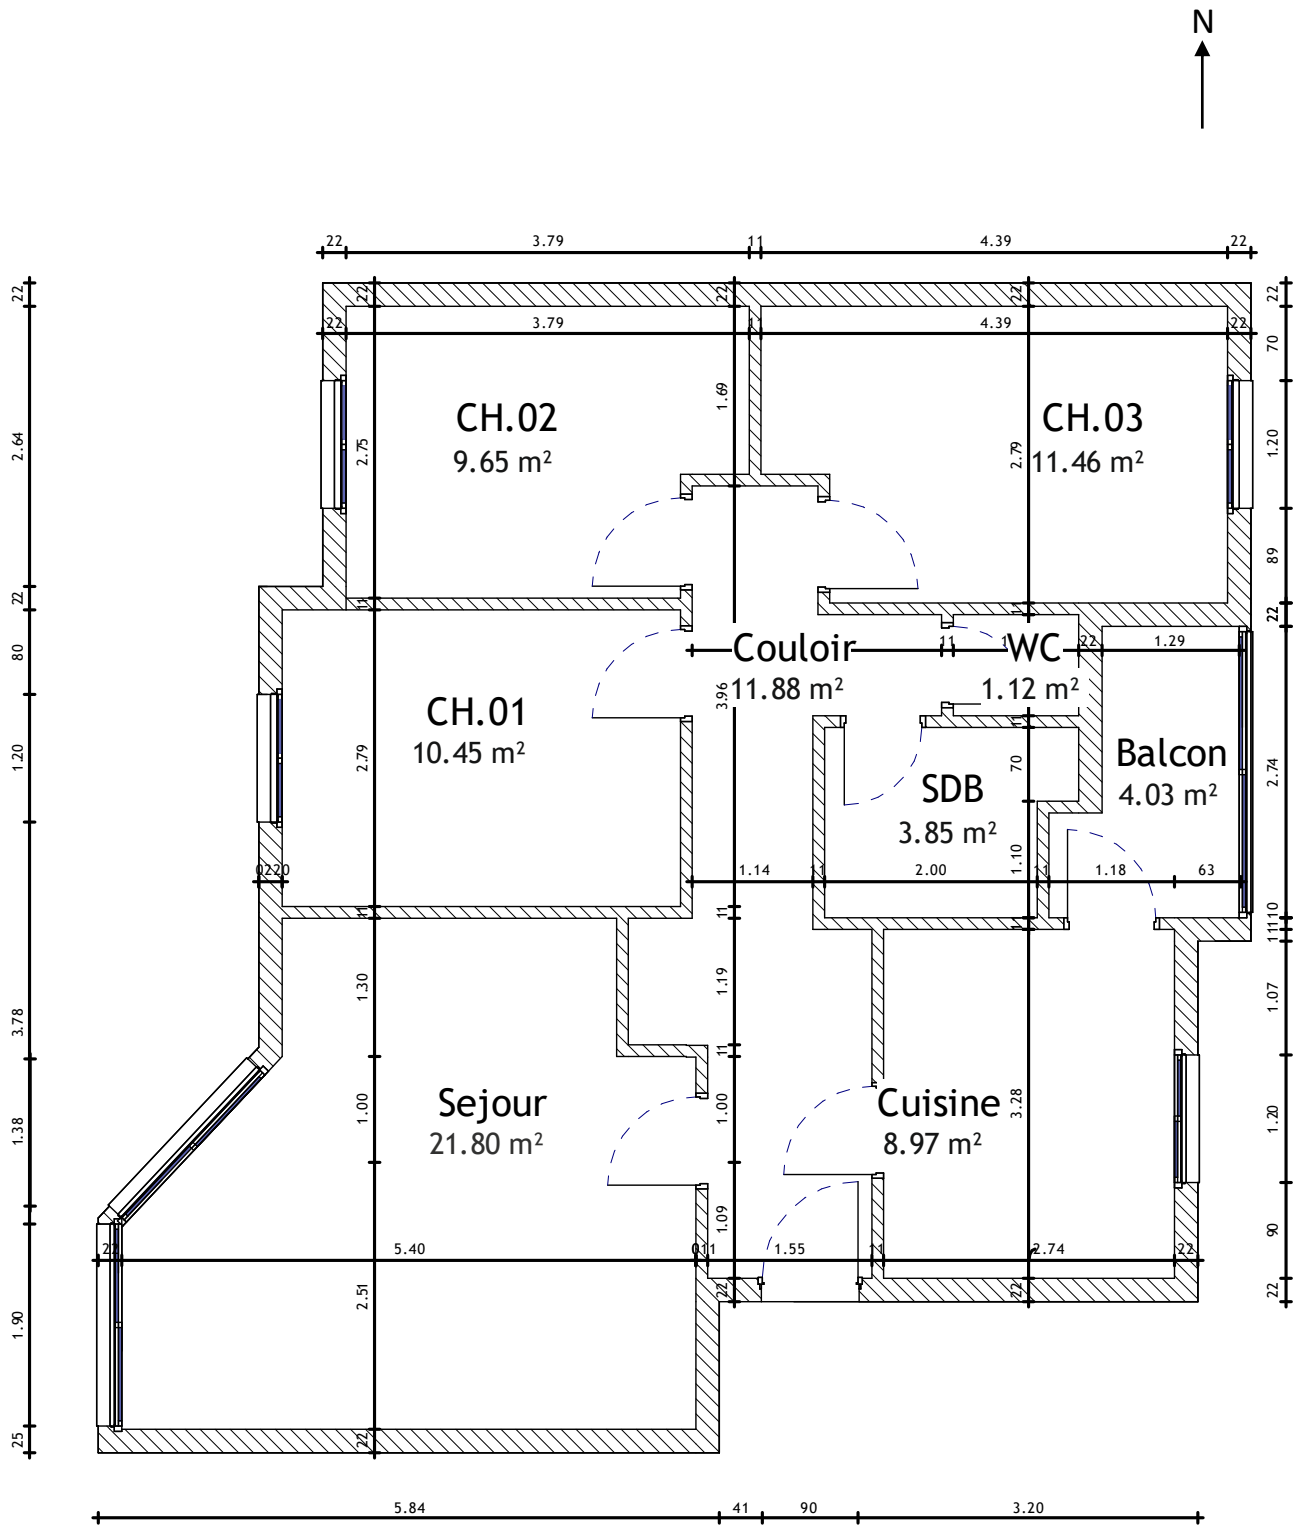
Plan du logement réalisé sur Autodesk Revit
